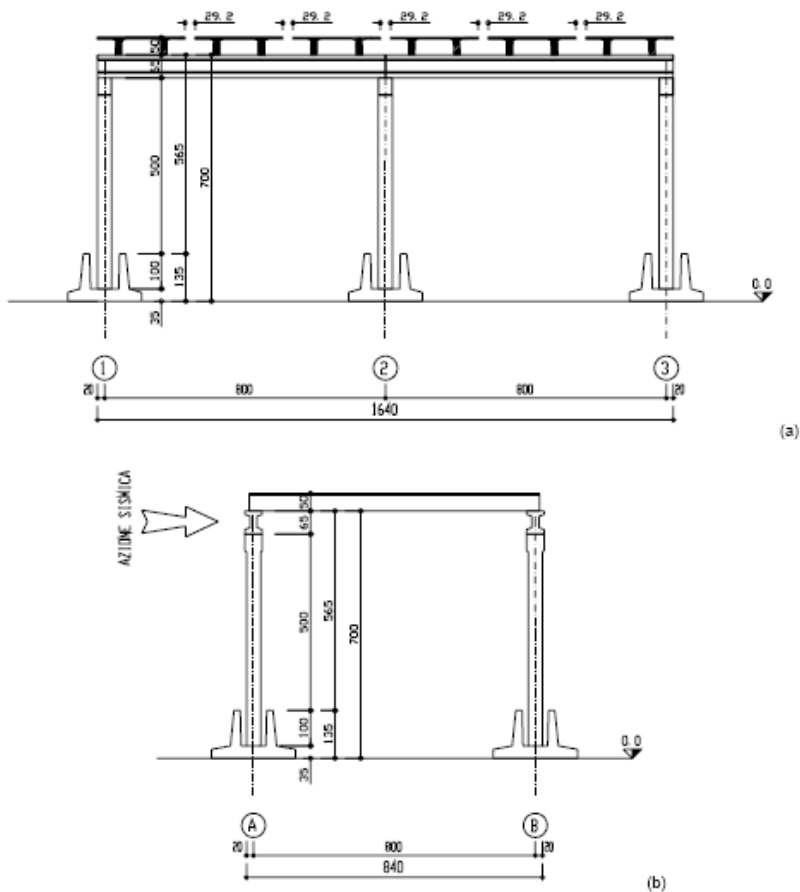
Prototipo con elementi di copertura disposti parallelamente all'azione sismica. (a) Prospetto frontale. (b) Prospetto laterale.
